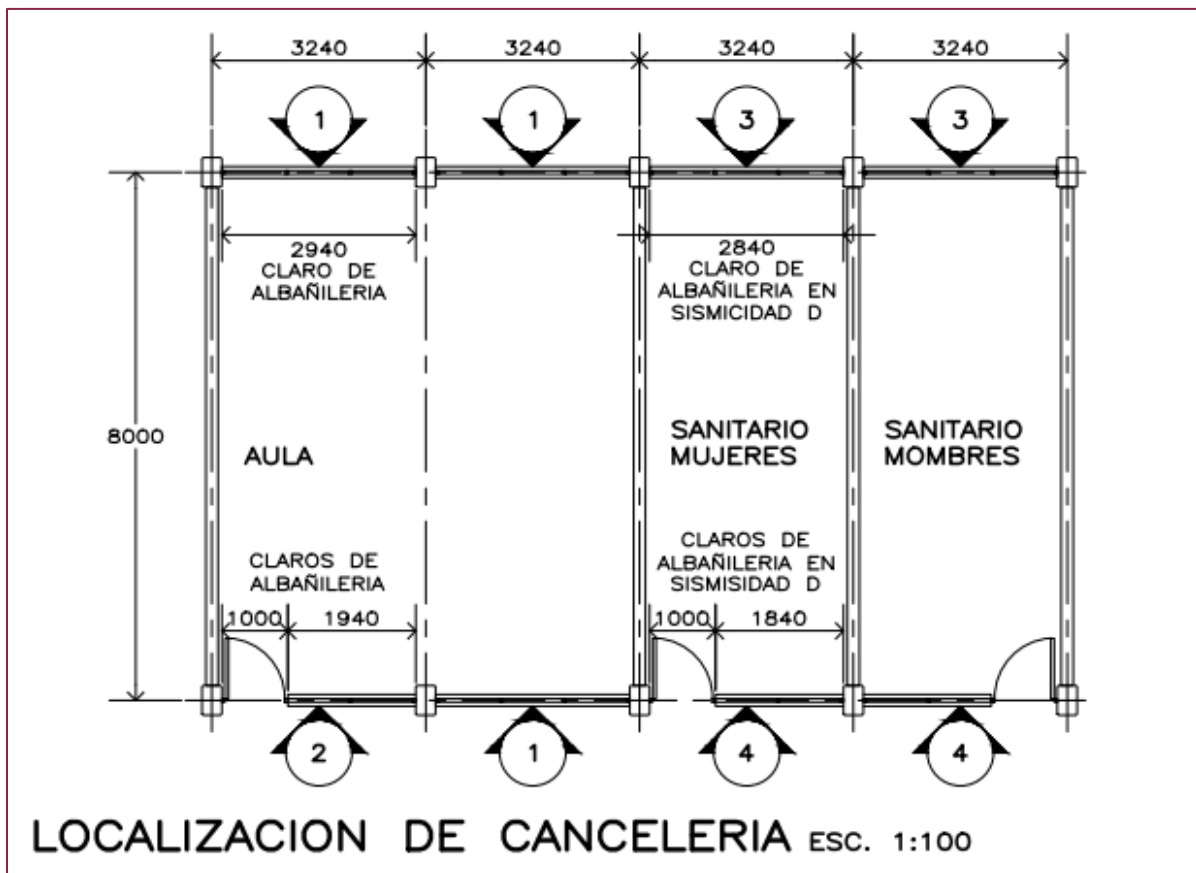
Plano en planta, para señalar elementos que requieren cancelería
